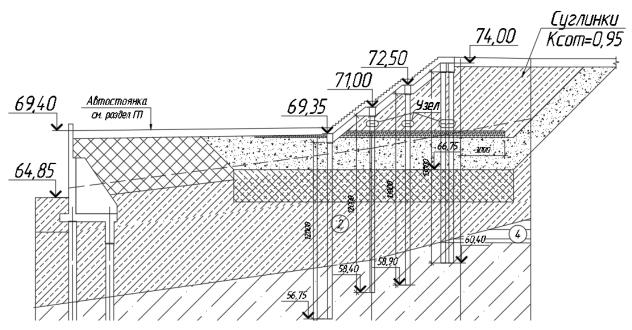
Железобетонный косоур на сваях в теле насыпи
